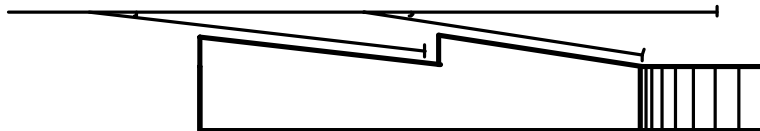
Schema di un piano cariatore scoperto a "dente di sega".
